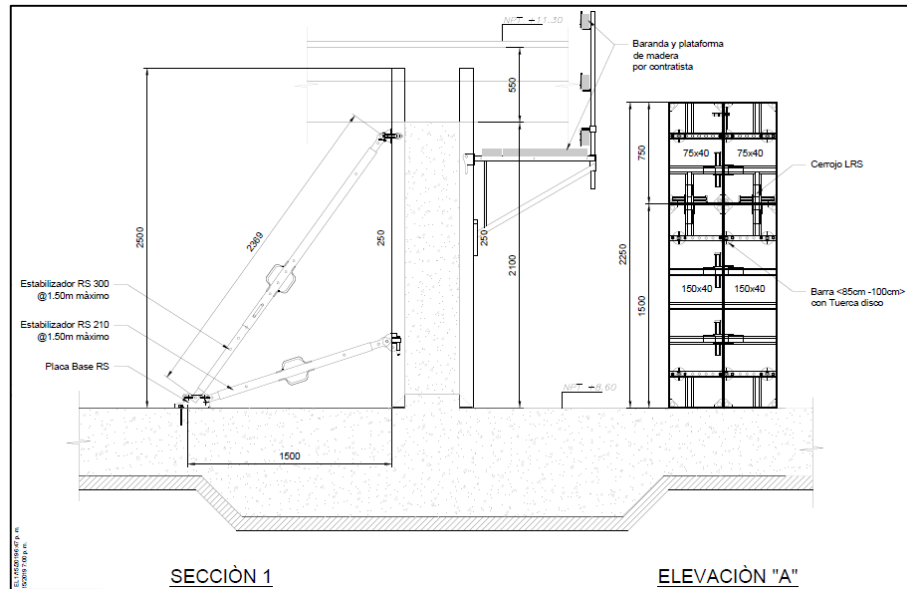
Detalle de encofrado de columnas de agua tratada.
